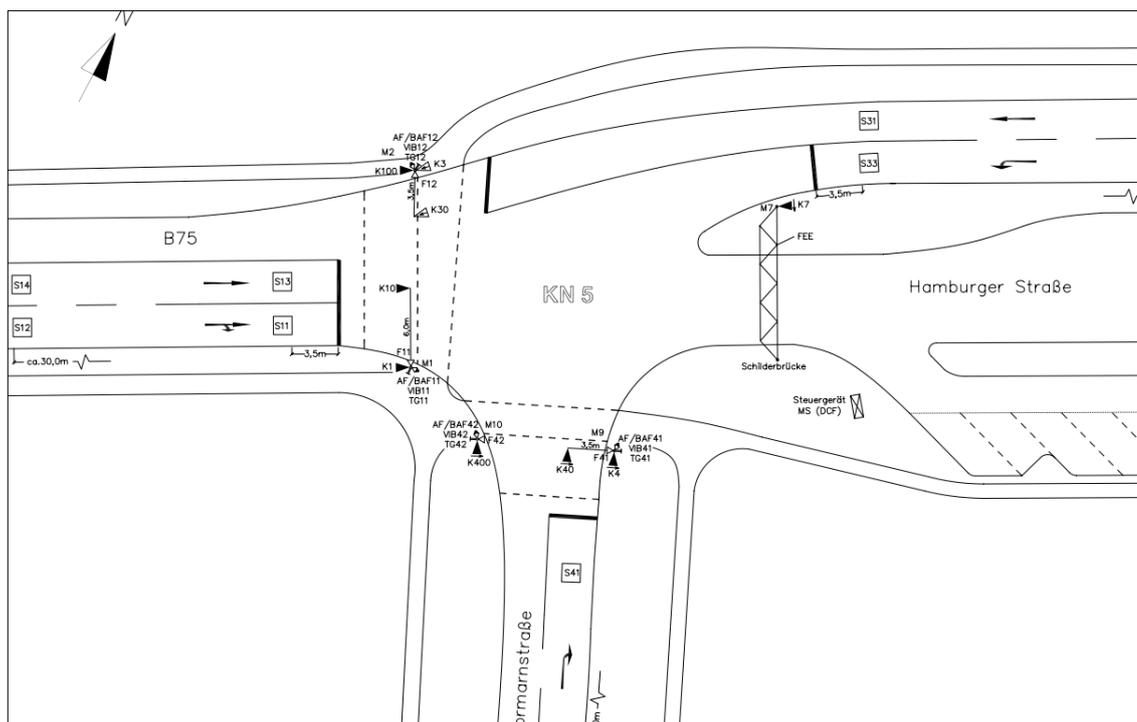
Knotenpunkt Hamburger Straße/Stormarnstraße – Signallageplan
